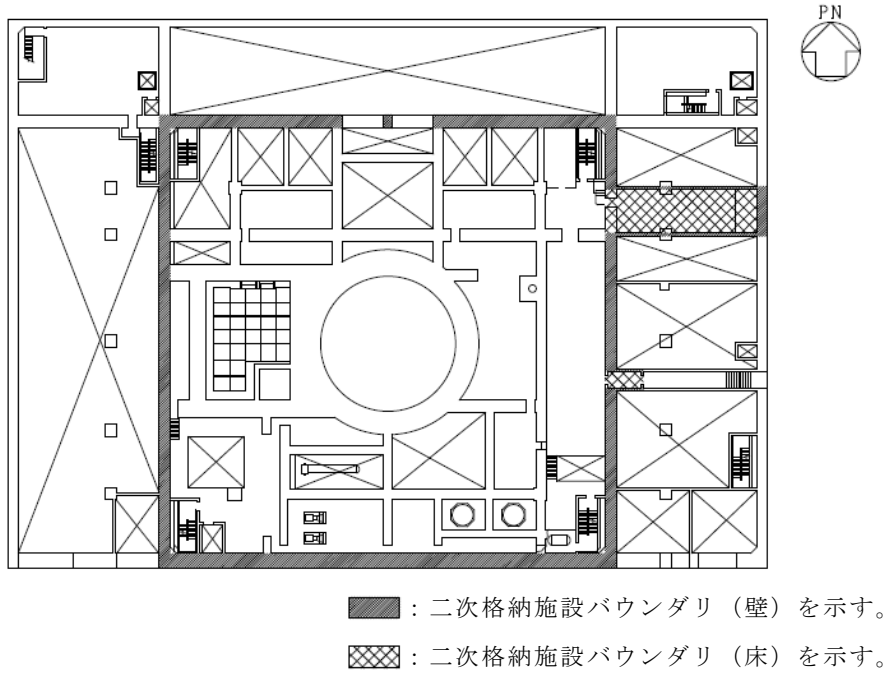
(7) 原子炉建物原子炉棟 (二次格納施設) の範囲の平面図
